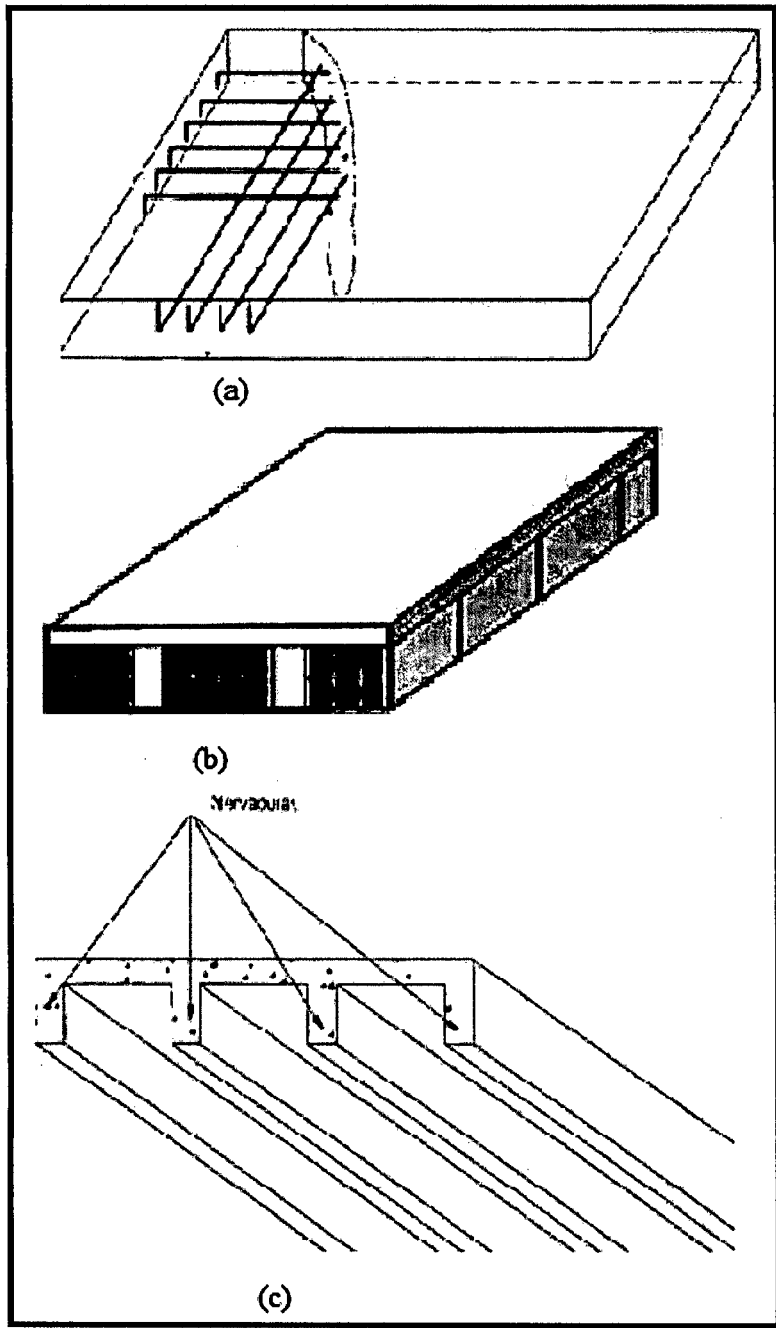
14: Tipos de losas (a) losa maciza, (b) losa aligerada, (c) losa nervada (adaptado de Blanco, 2011).
